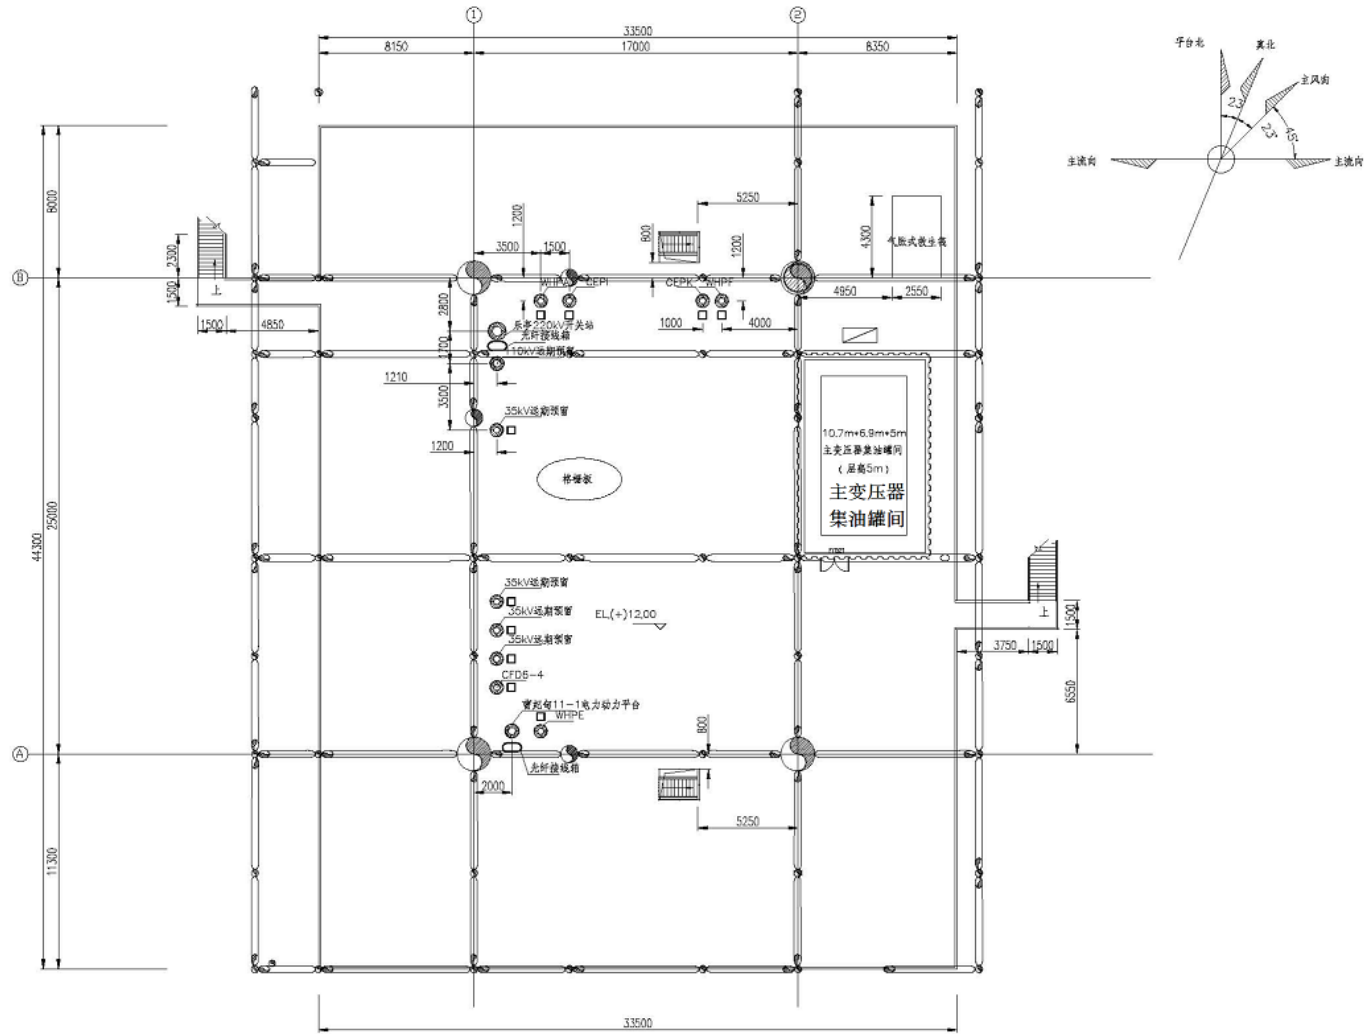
QHD32-6 EPP 平台工作甲板平面布置图
